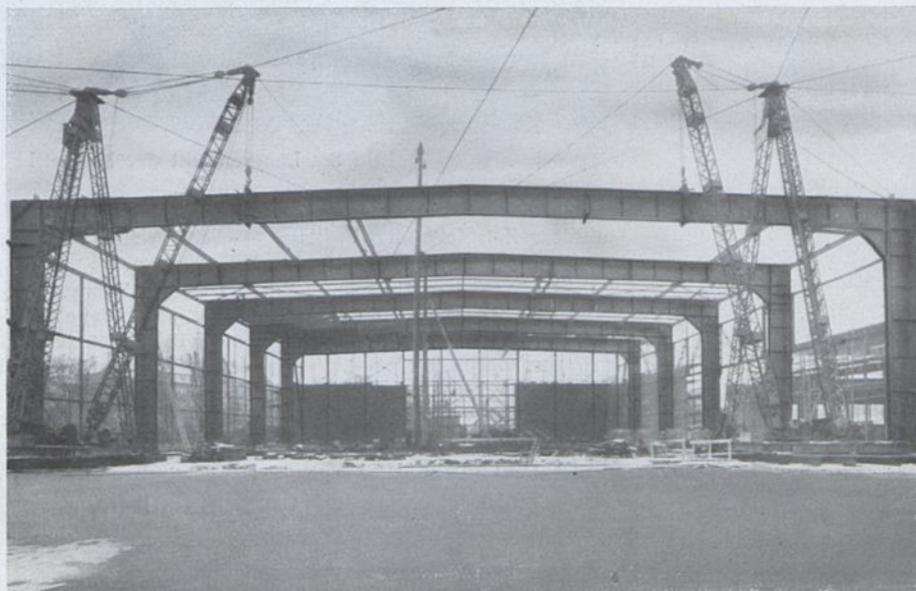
Halle 21a. Bauzustand am 21. Dezember 1937.
